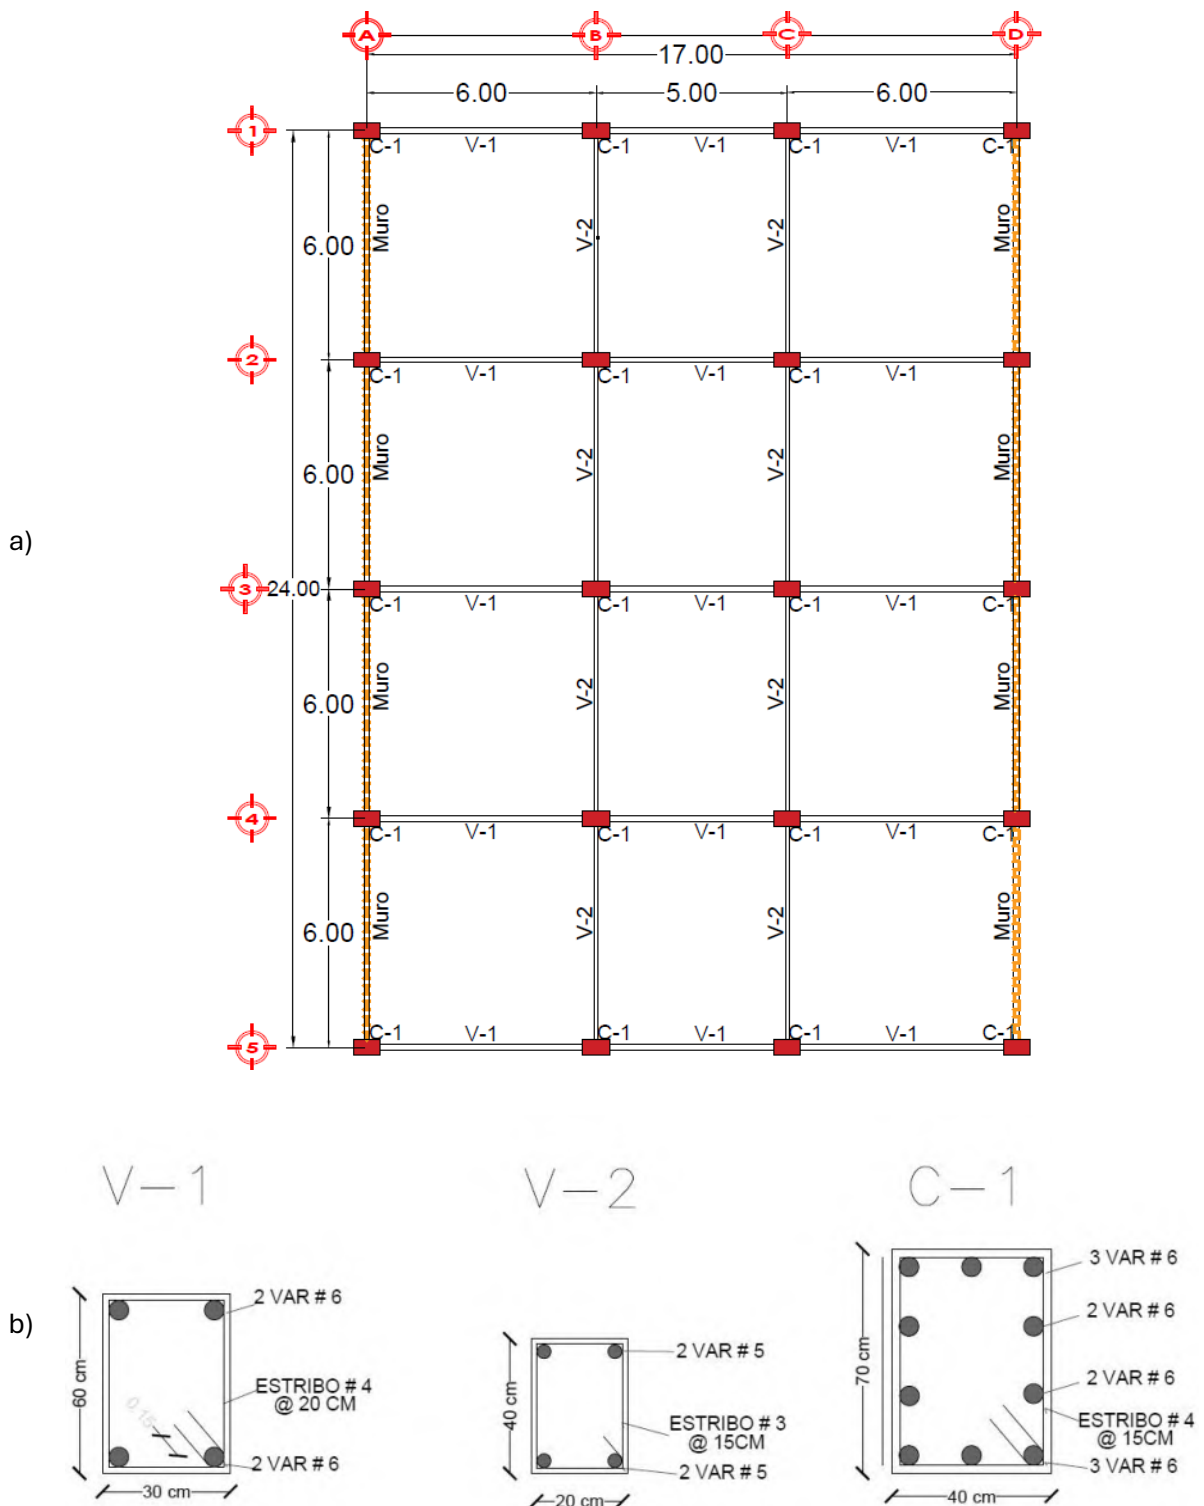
Configuración estructural del edificio: a) planta estructural, b) secciones armadas.
